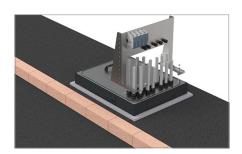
Aufsetzen Einstelllehre und Fixierung an Einpressbolzen und mittels Sechskantschraube.
